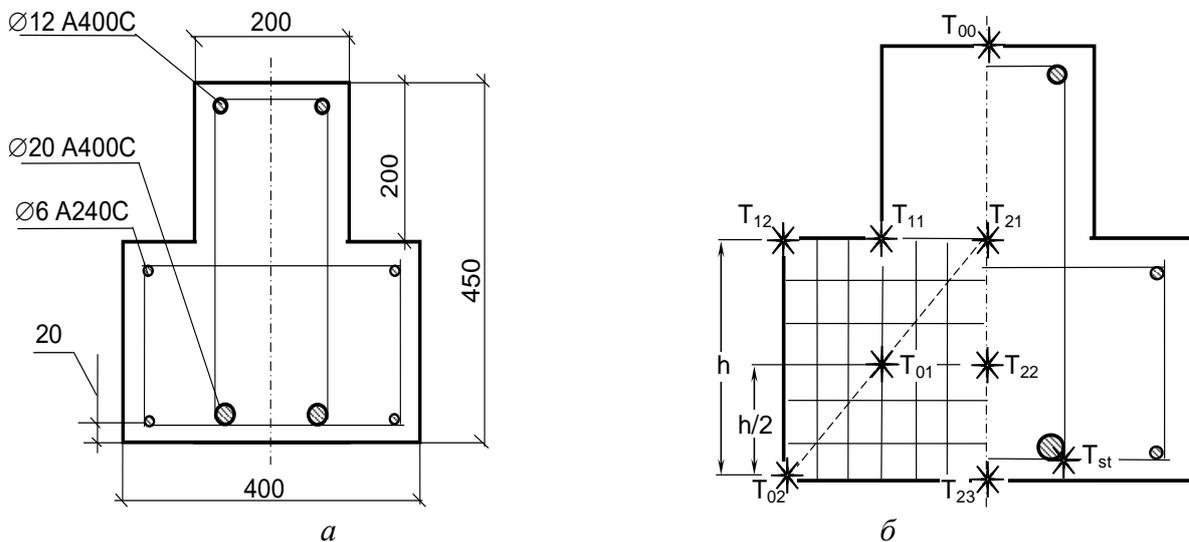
Конструктивна схема залізобетонного ригеля – а; схема розташування термопар для контролю температур у внутрішніх шарах залізобетонного ригеля – б
